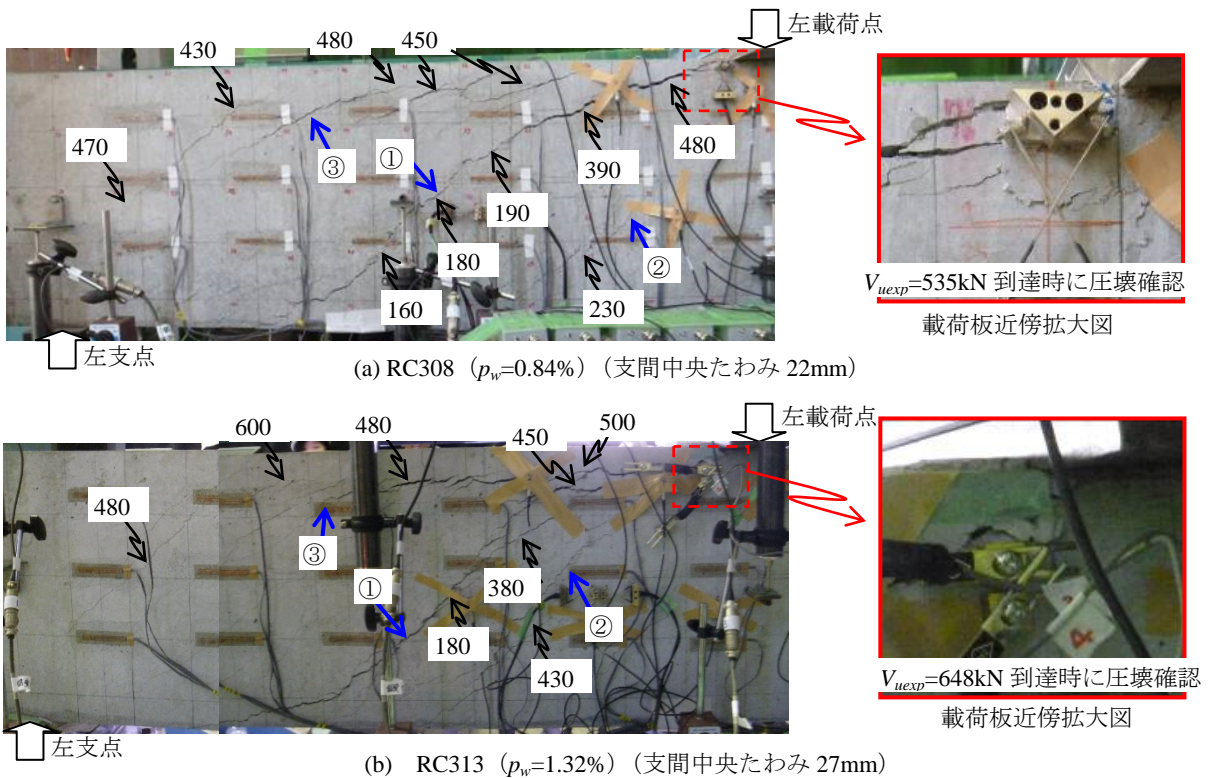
ひび割れ発生状況 (図中の数値は主たるひび割れ発生時のせん断力(kN)を意味する)
